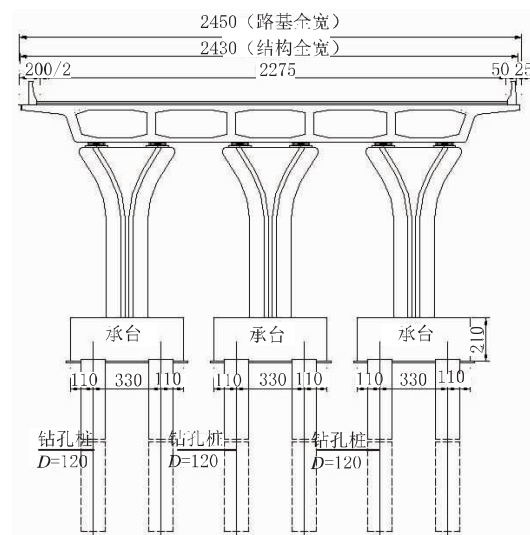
24.3 m 现浇梁标准断面 (单位: cm)
